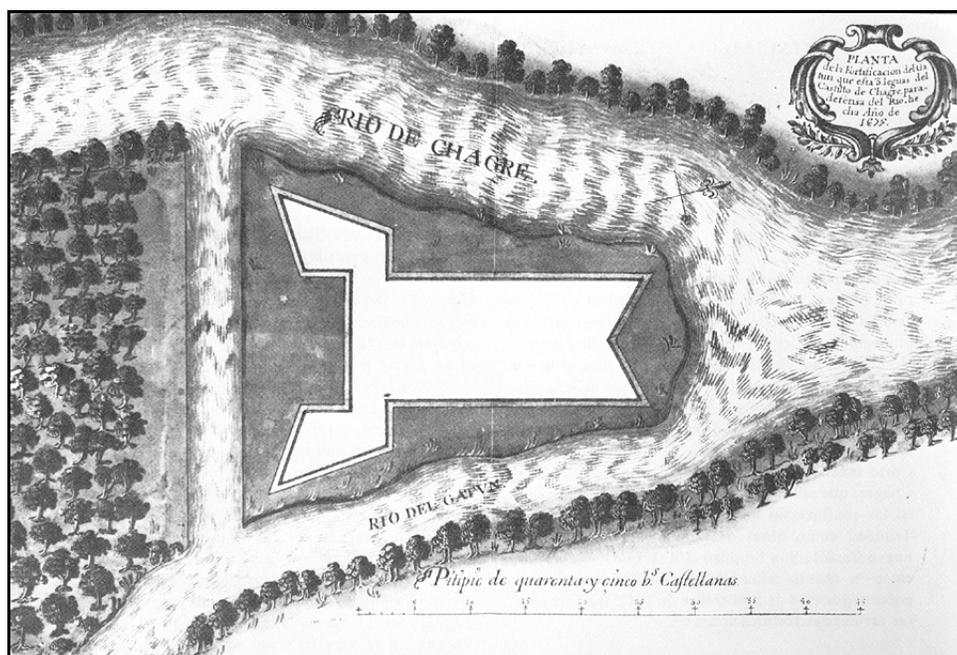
El primer Fuerte de Gatún, construido en 1675 (Zapatero 1985: lámina 21).
